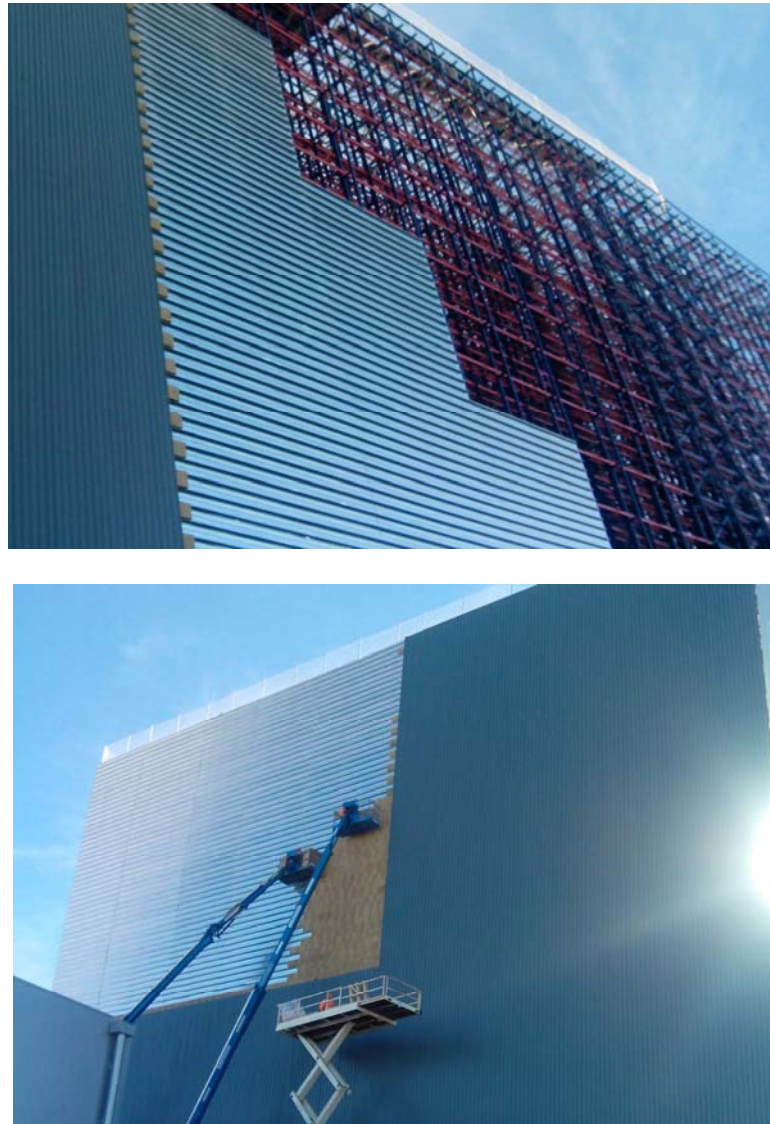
CERRAMIENTO EN FACHADA DE ESTANTERIA AUTOPORTANTE CON SÁNDWICH IN SITU SIN CORREAS
